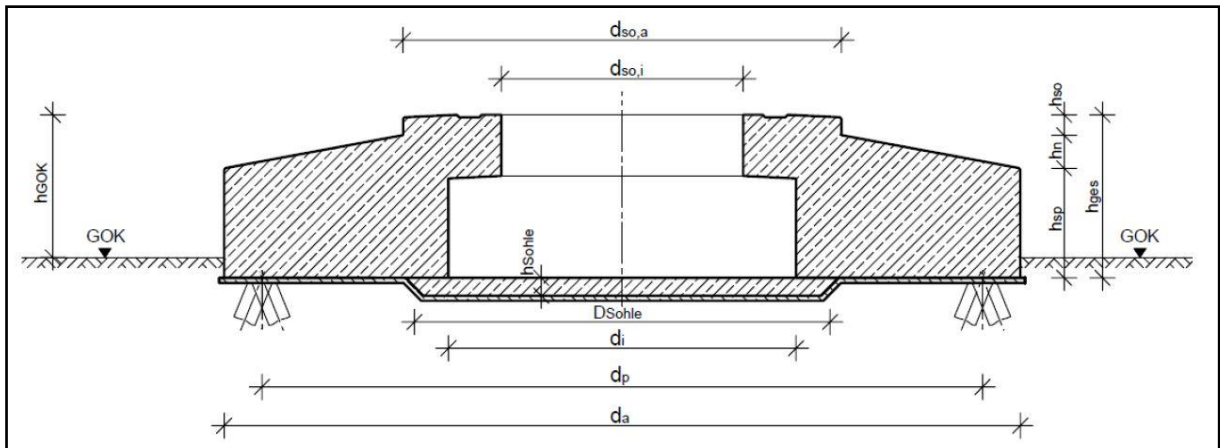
Schéma d'une fondation dite 'hors sol' (source : Enercon, 2021).
